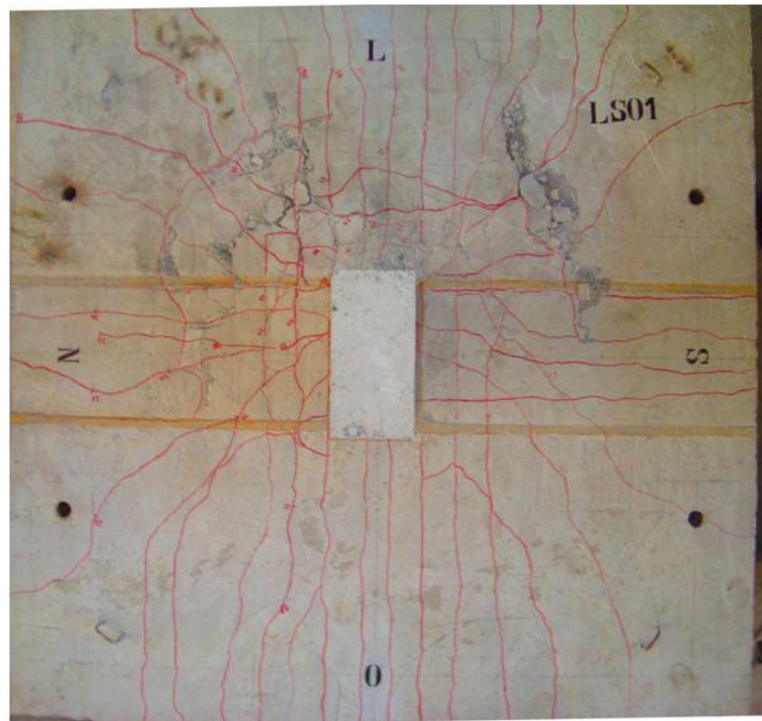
Padrão de fissuração do modelo LS01.
